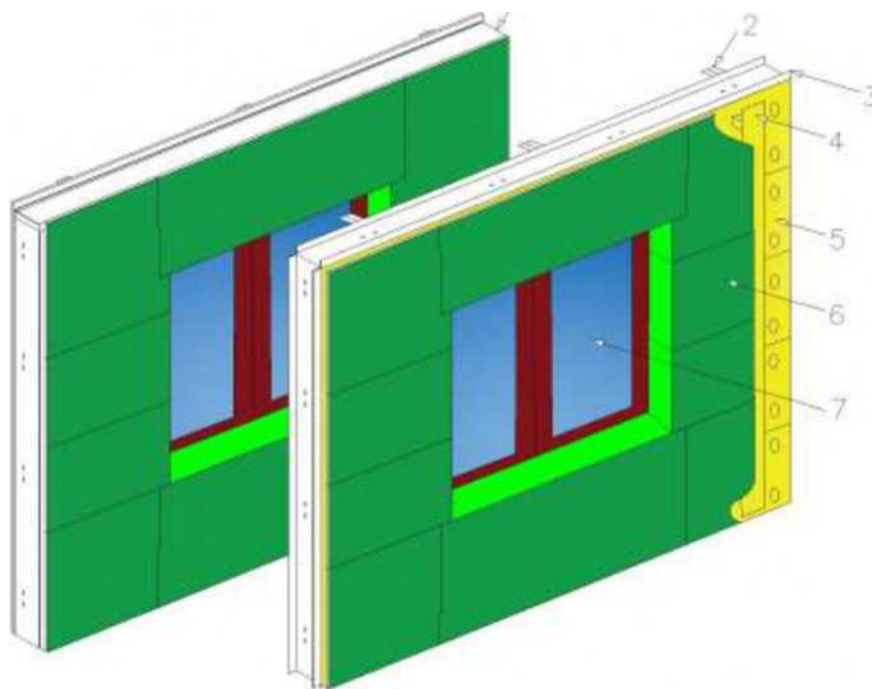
Фрагмент вентилируемого фасада, возводимого методом укрупнительной сборки: 1- специальный замковой профиль - U (гребень); 2-кронштейн;3- специальный замковой профиль -H (паз); 4-подконструкция стеновой панели, формирующая воздушную прослойку; 5-утеплитель; 6-облицовочные элементы; 7-оконный блок;
